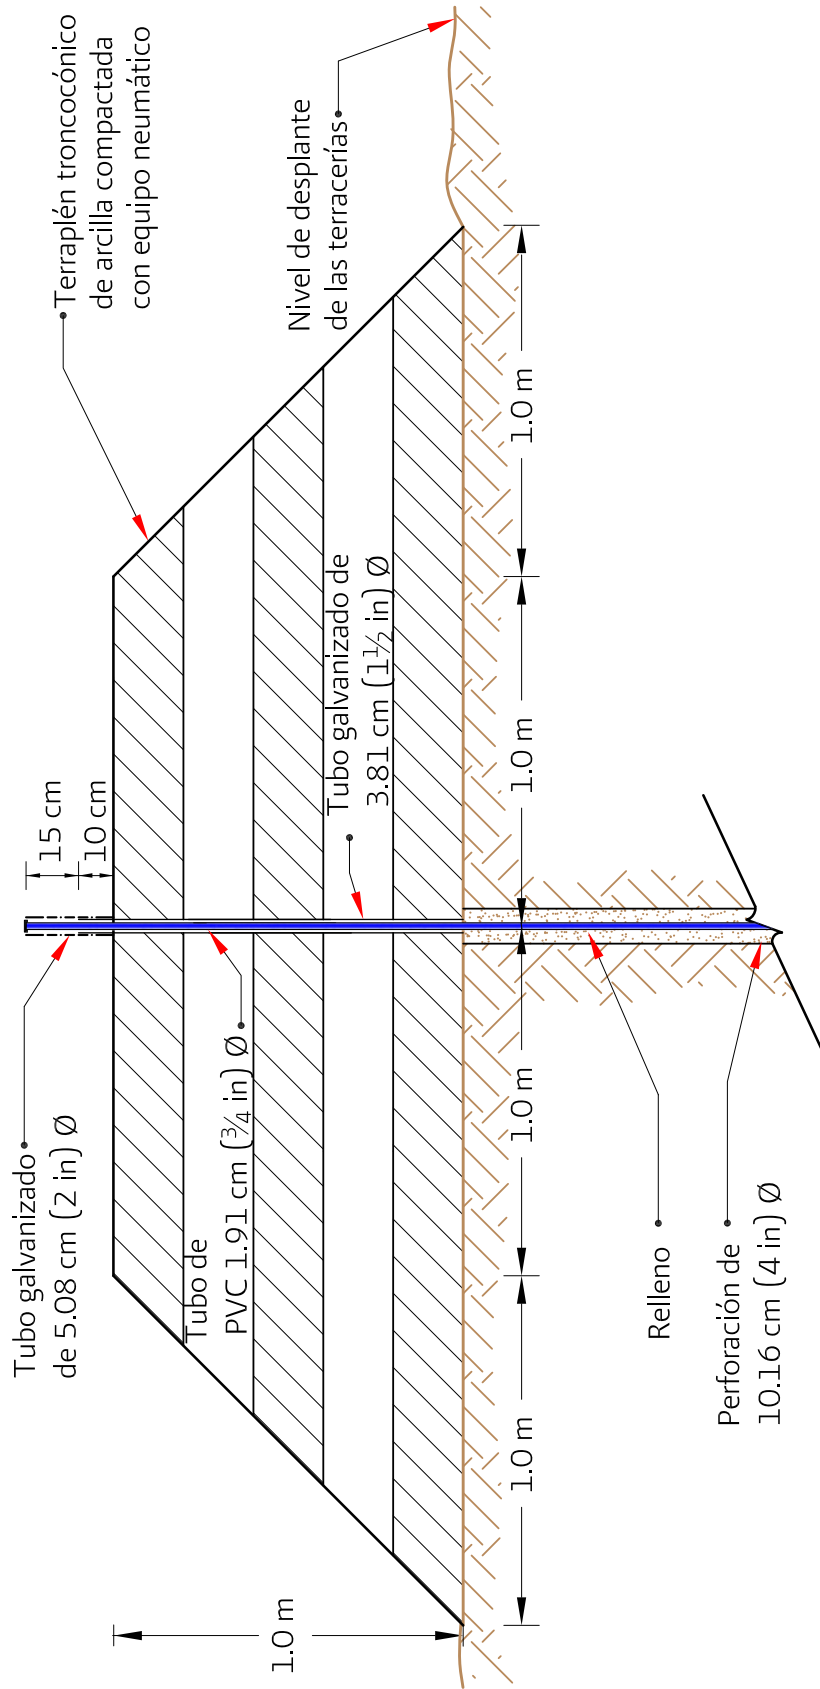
Terraplén para protección de tubería del piezómetro abierto instalado en la cimentación
